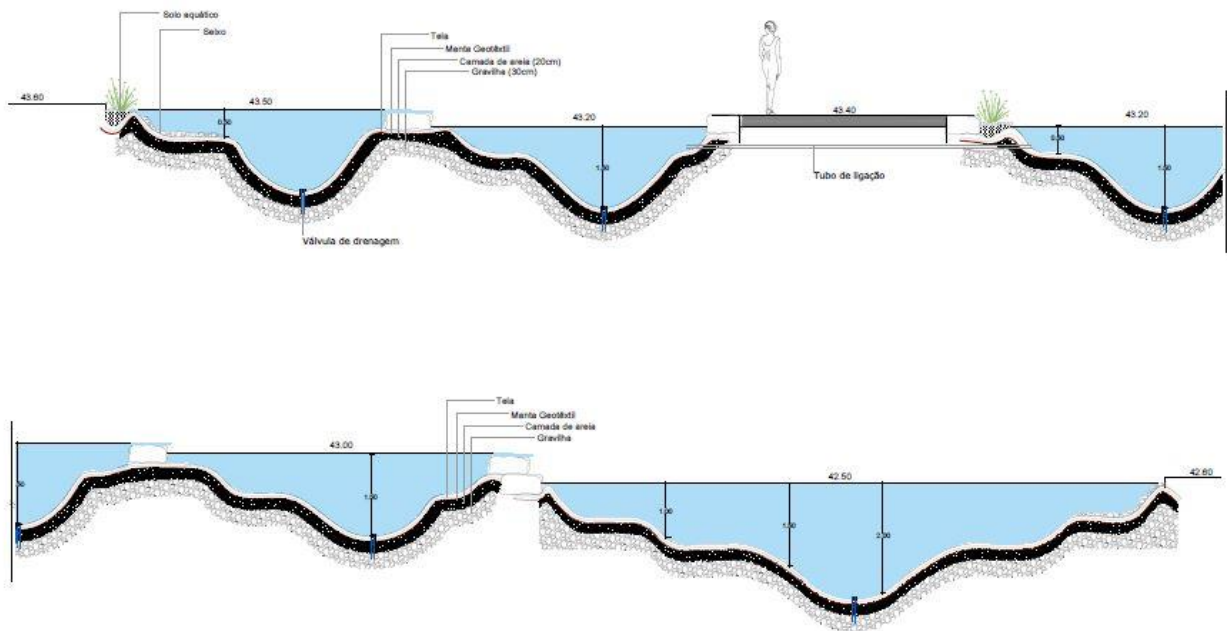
25. Representação dos Pormenores de Construção do Lago da Quinta Neoleta, Almancil. Fonte: Autora, 2022.
